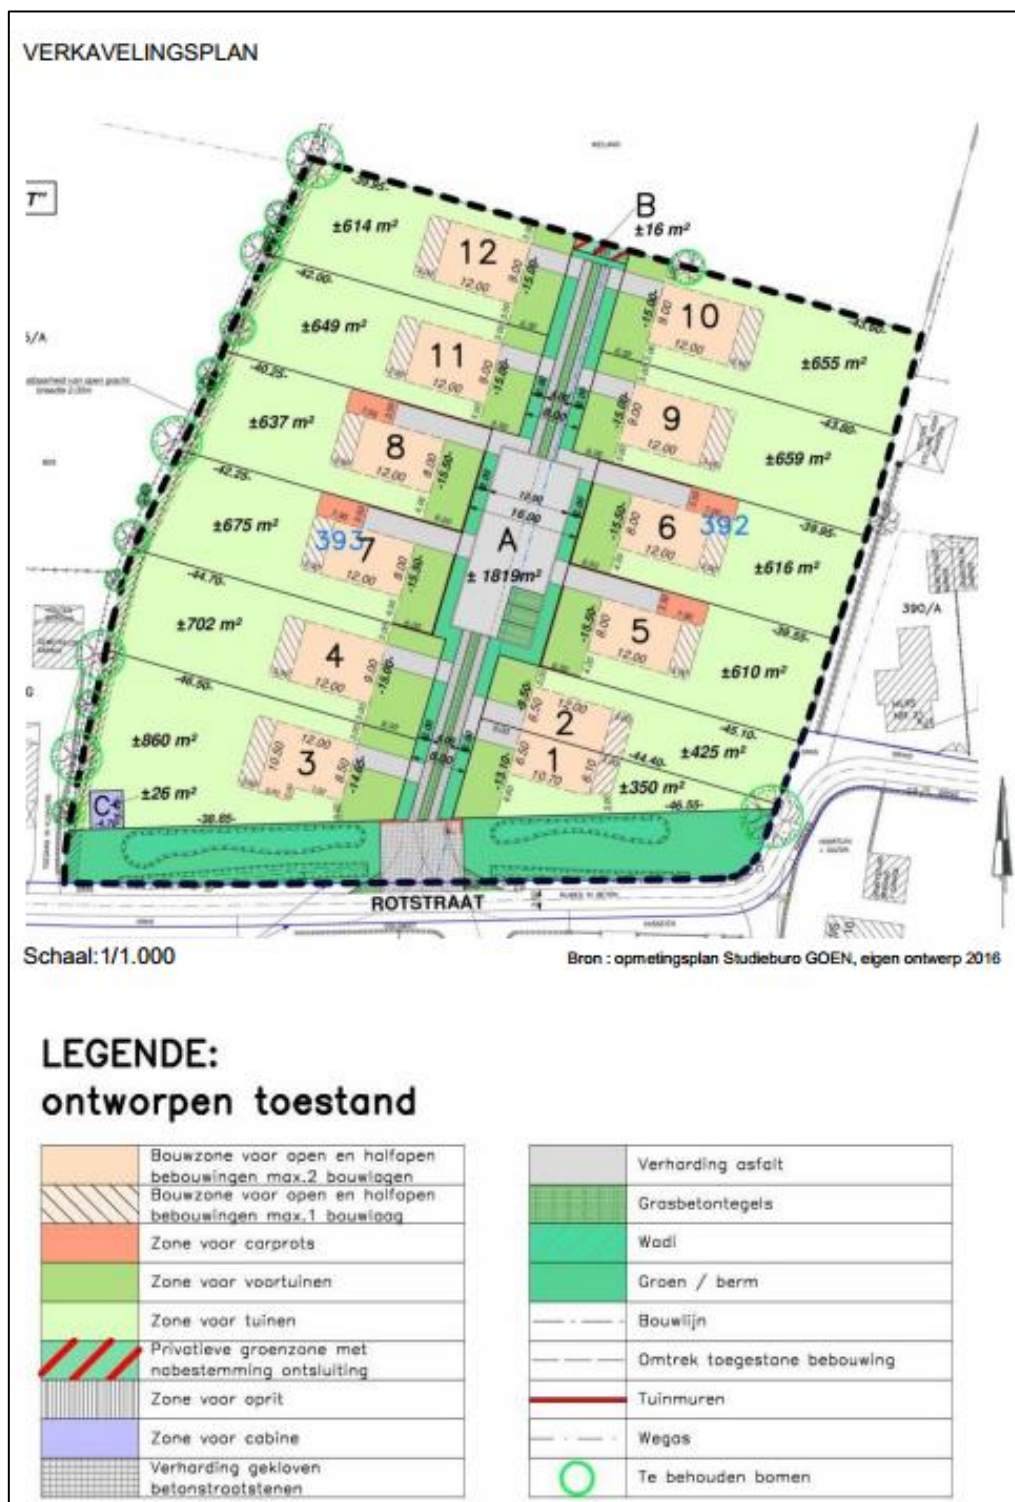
weergave van het verkavelingsplan (plot door BAAC op orthofoto)⁵
